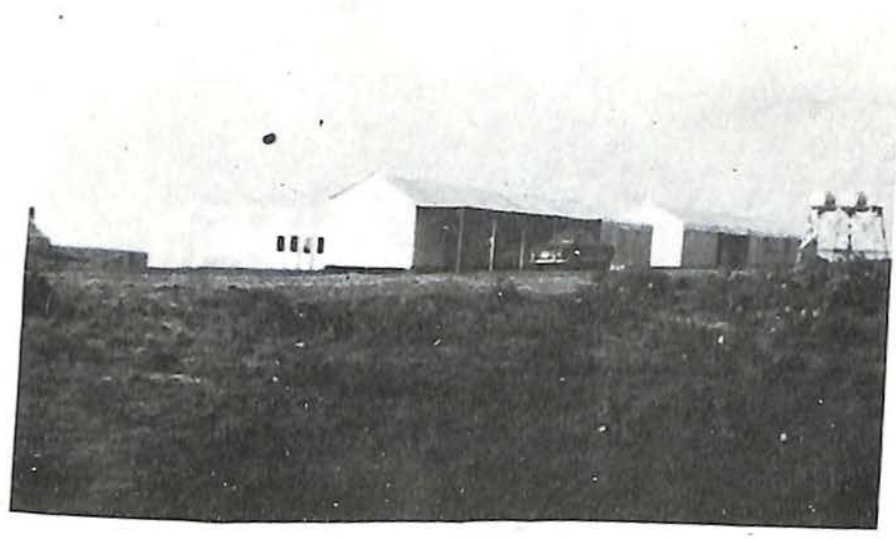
VISTA DEL CAMPAMENTO YA TERMINADO.
